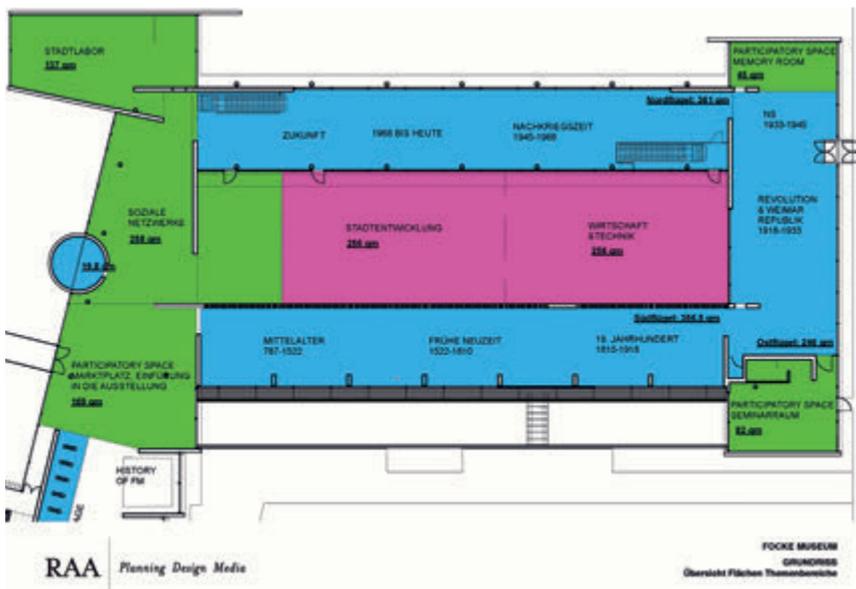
Grundriss der geplanten Sammlungsausstellung 2026.
